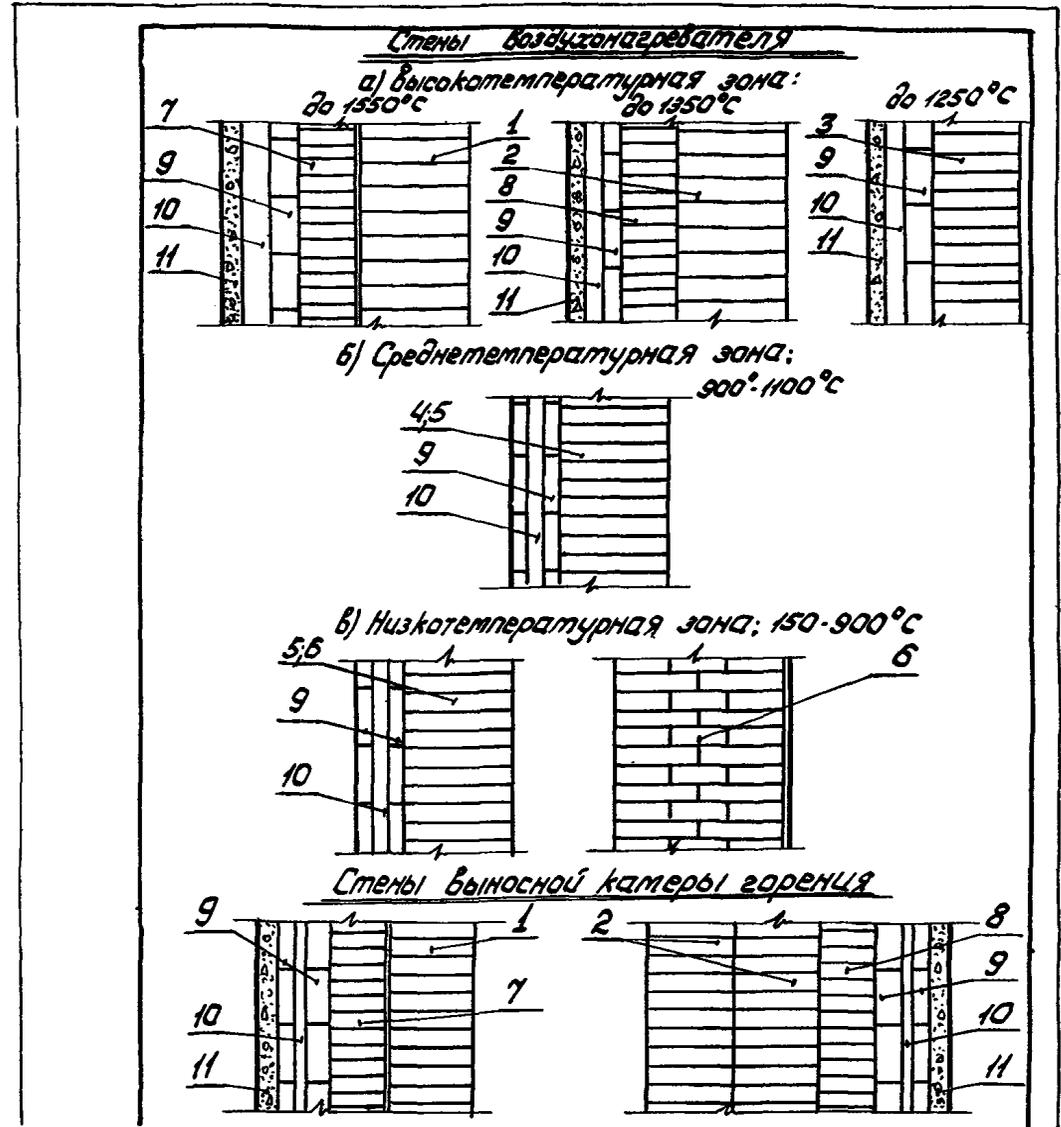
Кладка стен воздухоподогревателя и выносной камеры горения:
